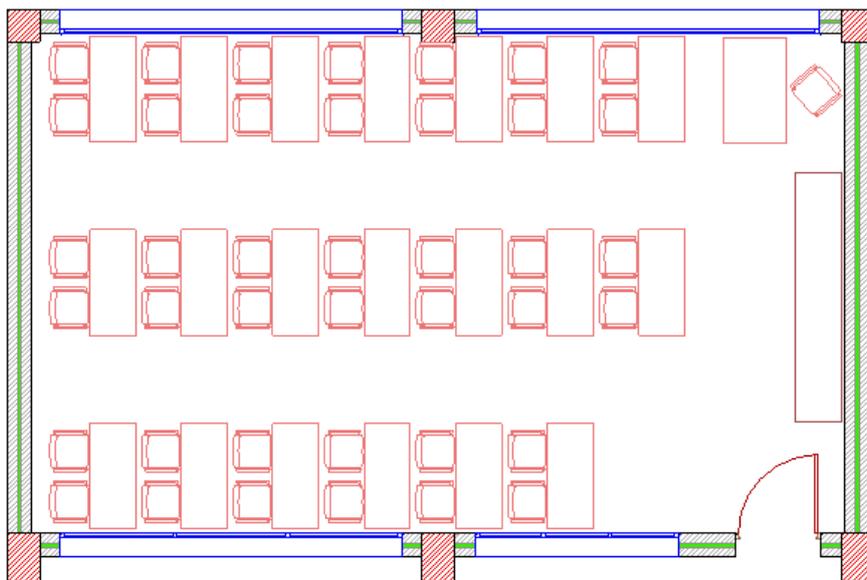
Plan type d'une salle de classe (Source : Auteur, 2021)
